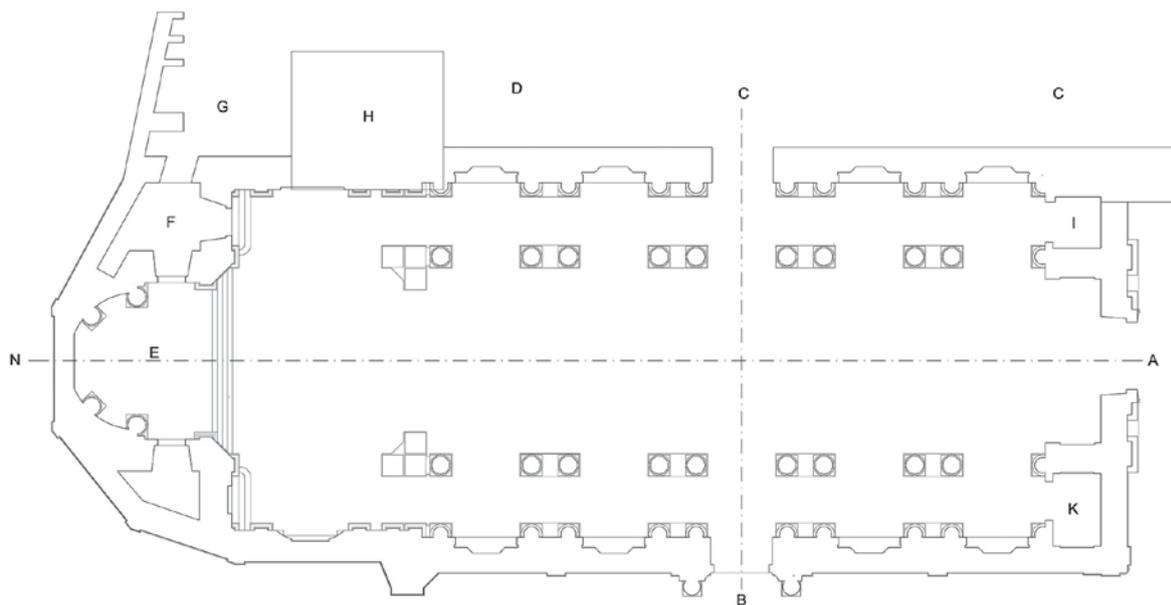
Planta de la Iglesia de San Juan. Planta. Autoría: M.D. Rincón Millán.
